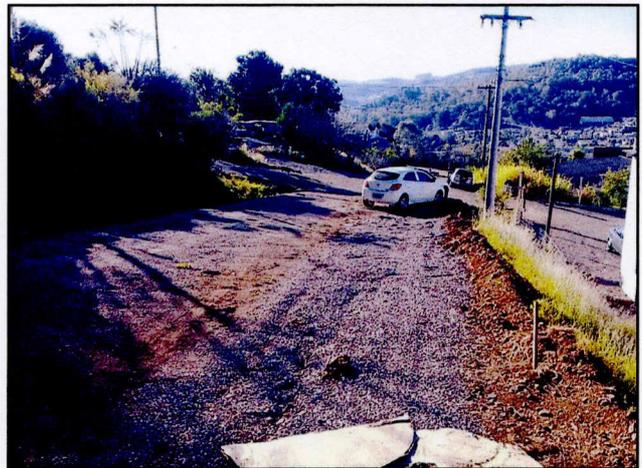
vista norte do leito da Rua existente a ser regularizada, conforme ponto 01 do projeto;
